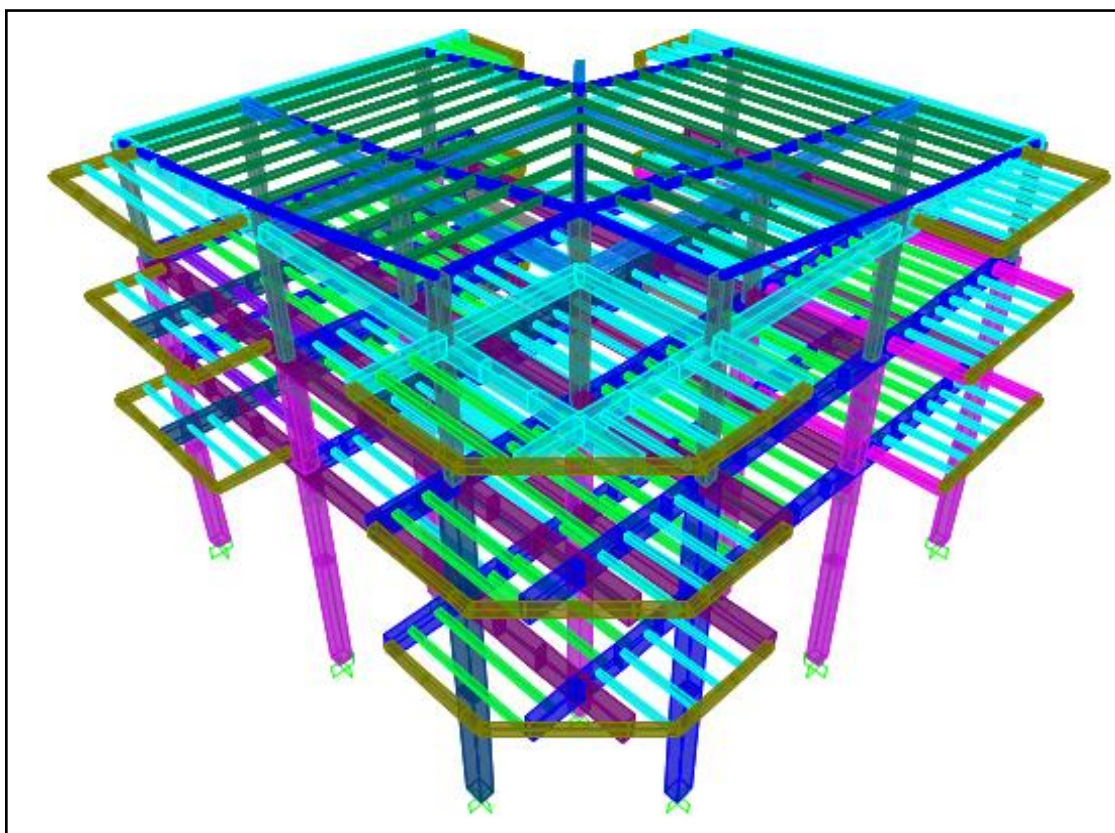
Vista en 3D del modelo estructural de la edificación en SAP 2000 v20.
